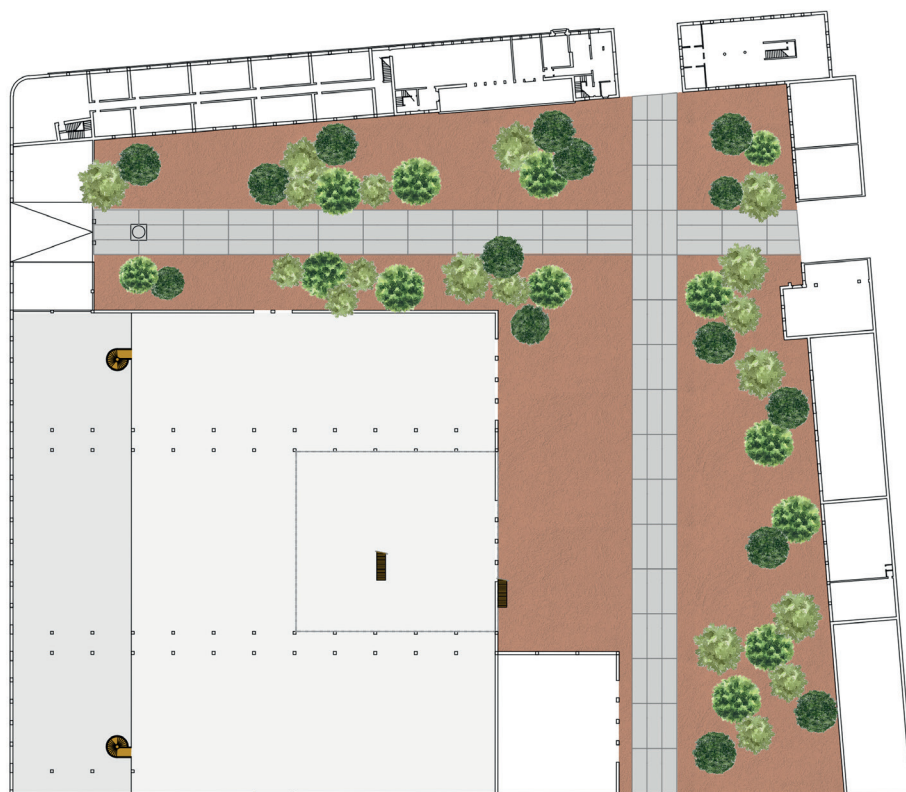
Planta do piso térreo da Fábrica Barros. Realizado em CAD pela autora.
